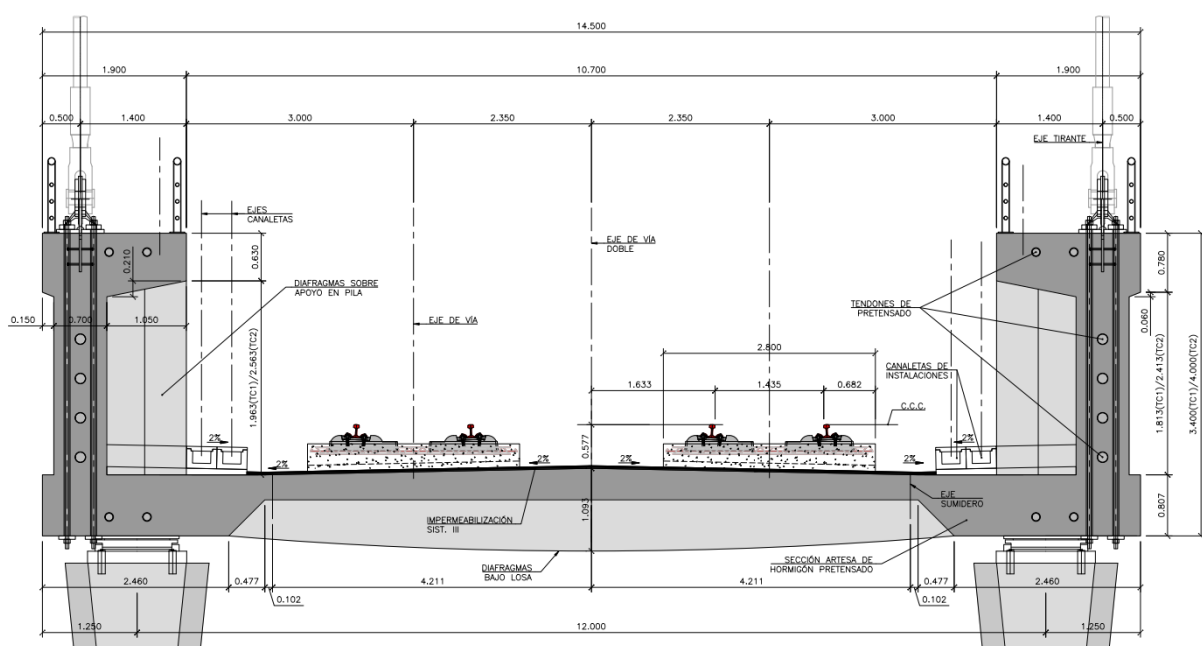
Sección tipo del Tramo Central del Viaducto de Hernani.
